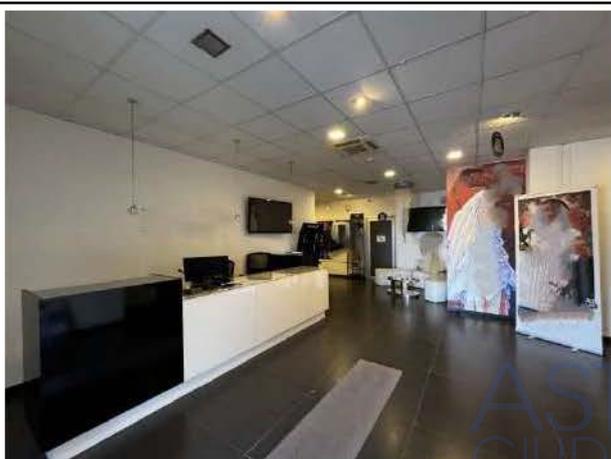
Diverse viste della reception di accesso. Si noti l'impiantistica a soffitto, protetta da controsoffittatura e la configurazione ad open space dei diversi comparti.
